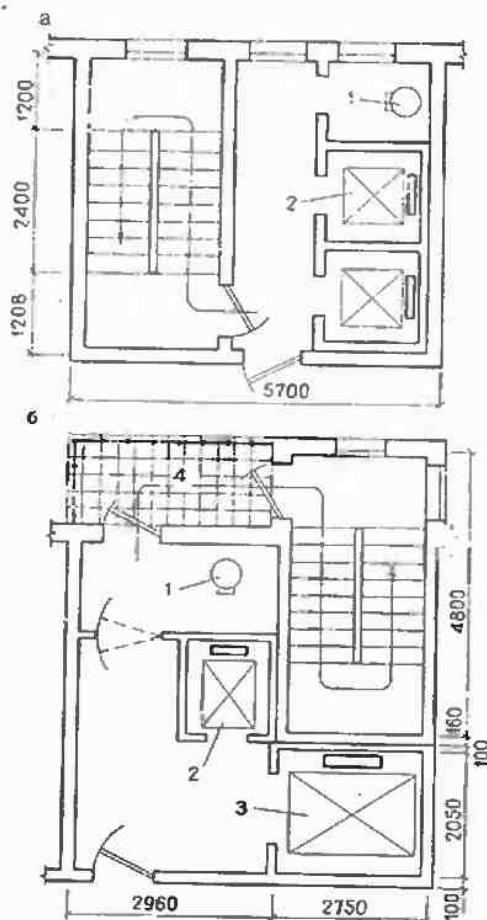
Планировочные решения лестниц в зданиях повышенной этажности
